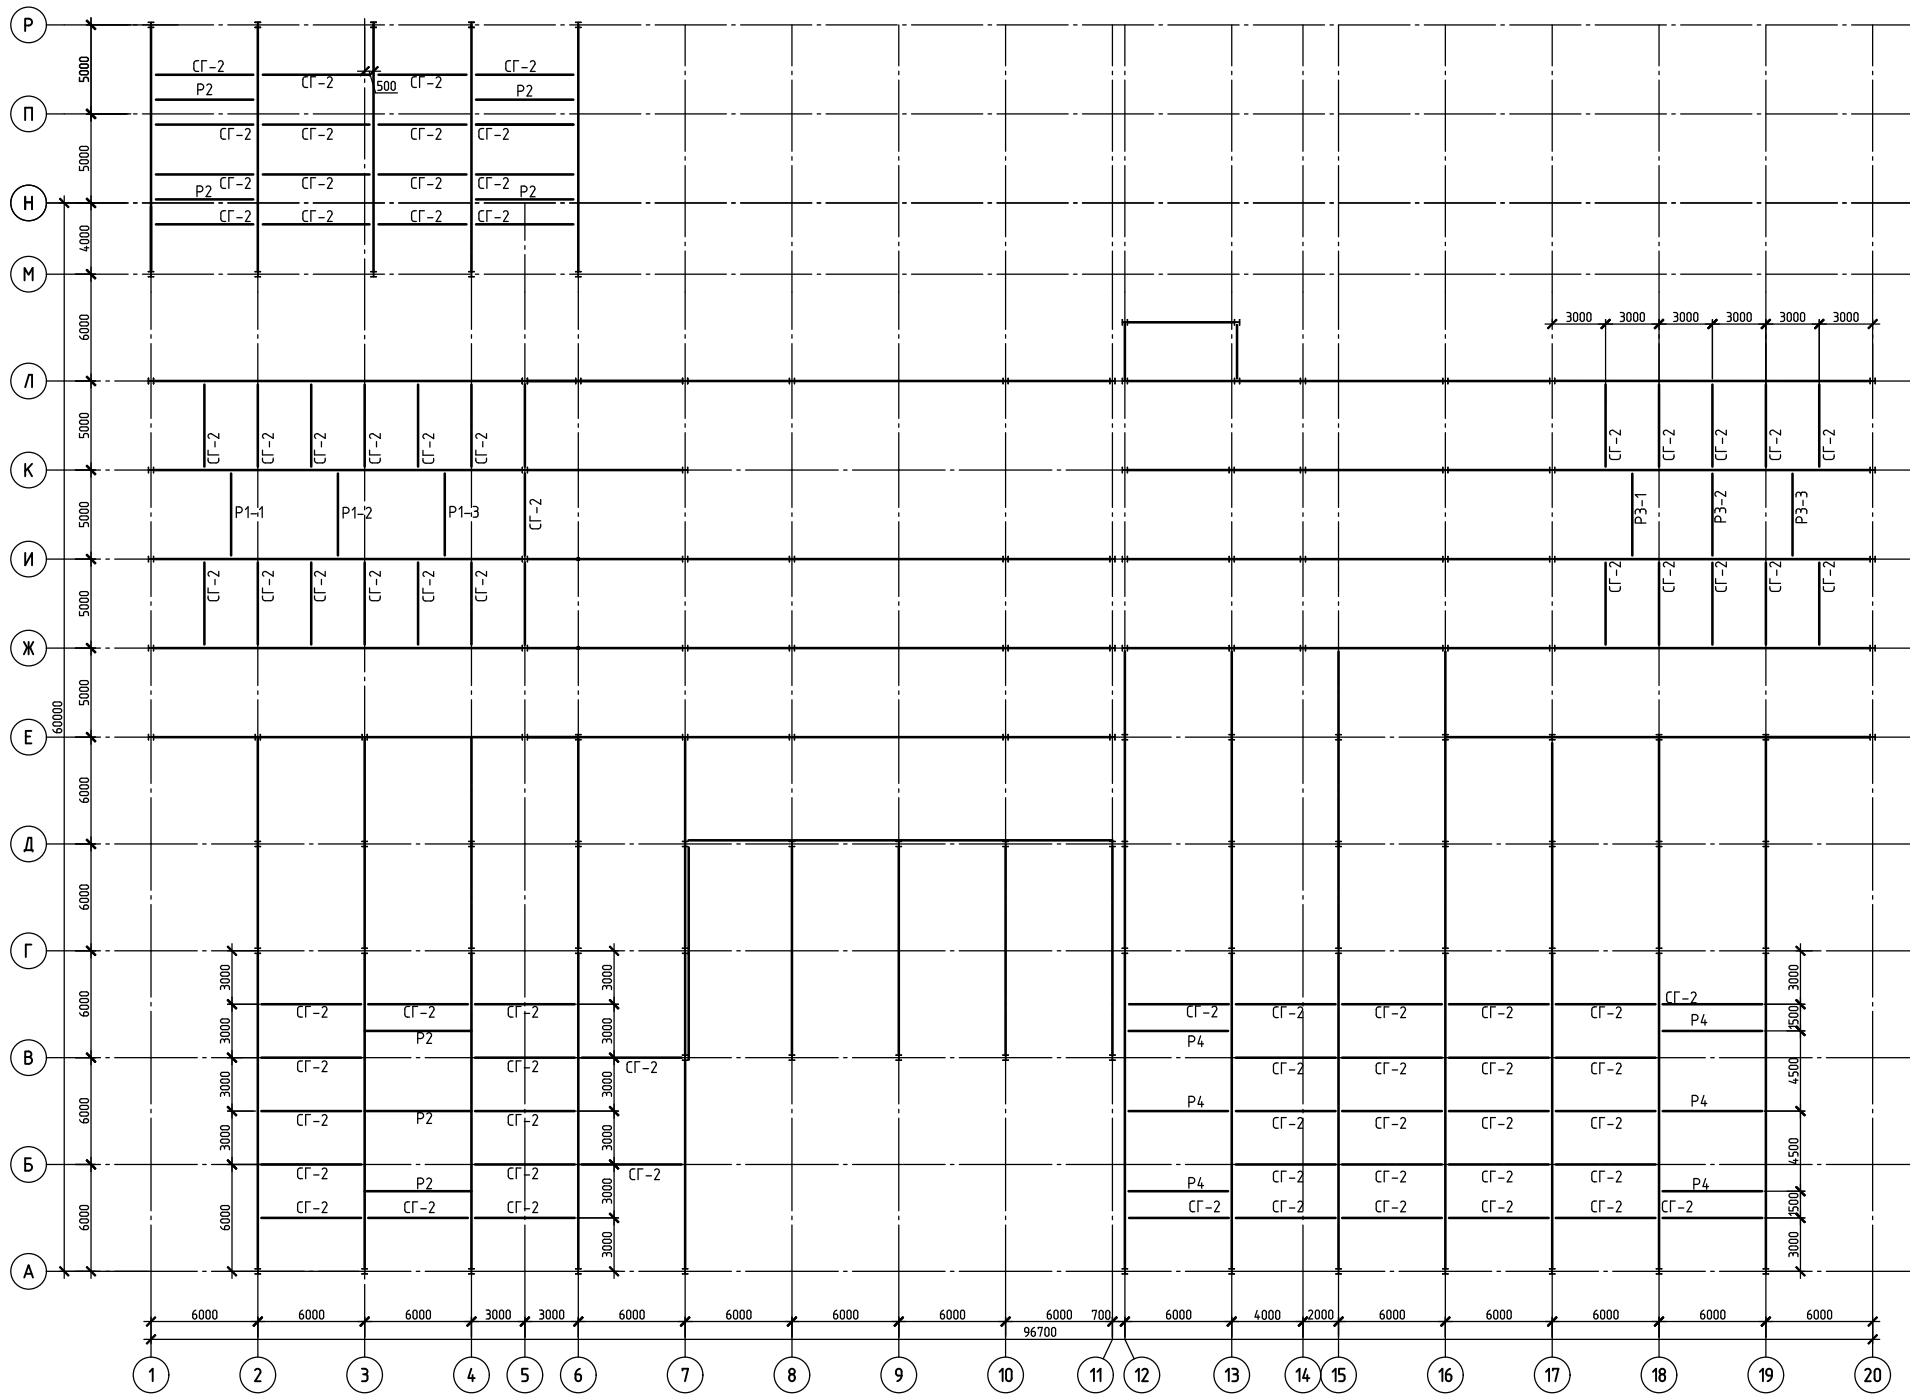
Связи по верхним поясам стропильных ферм
